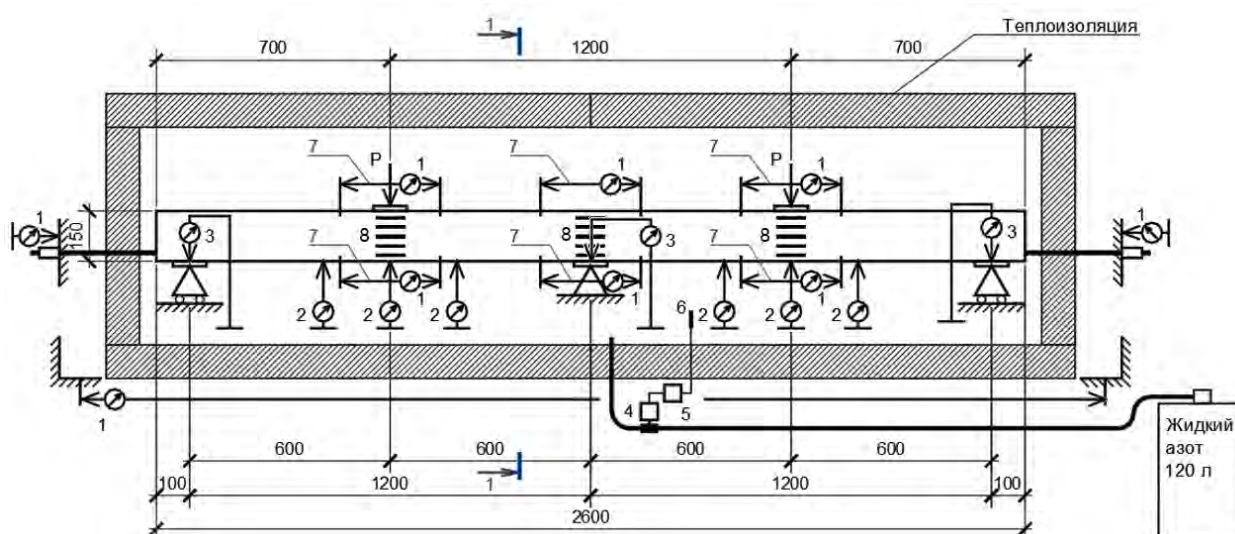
Схема испытания железобетонной балки в климатической камере:
